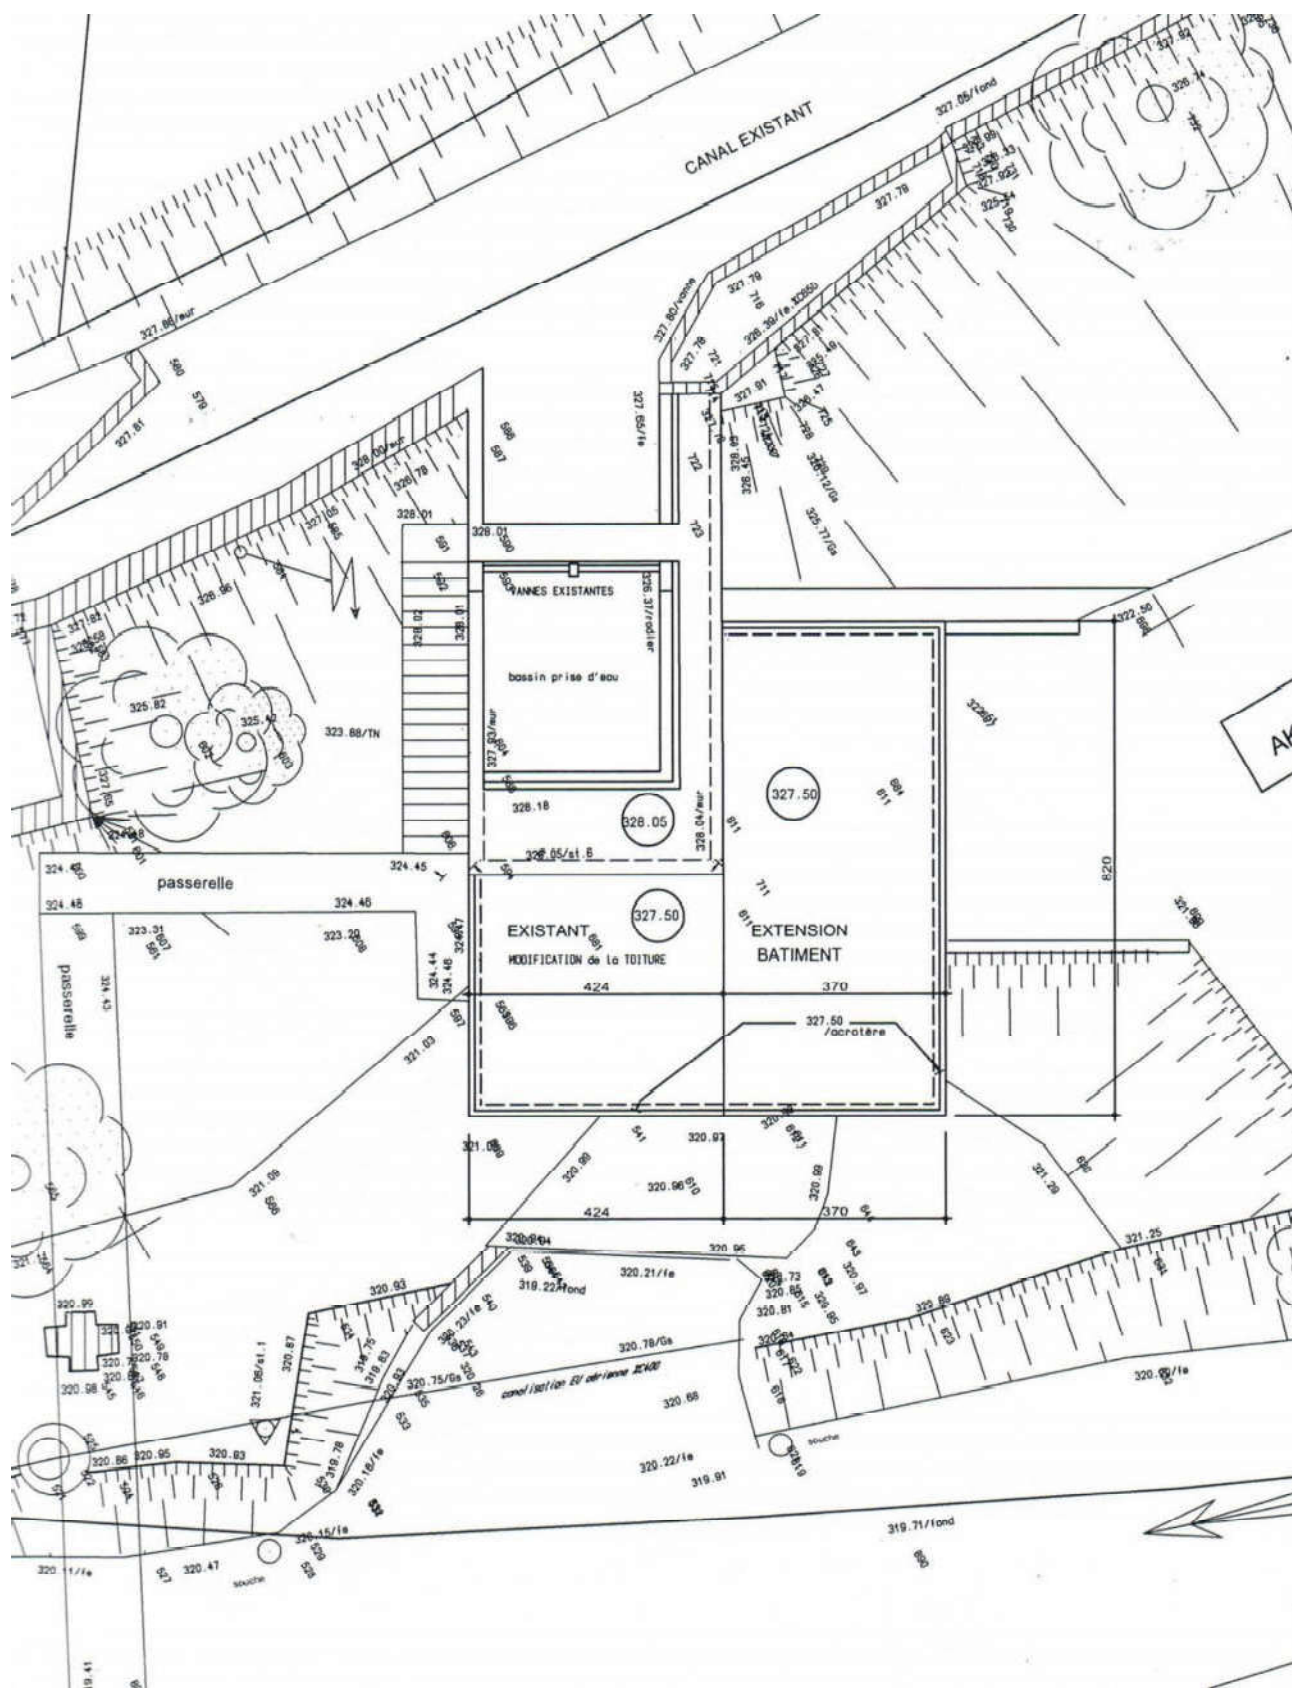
VUE EN PLAN DE L'EXTENSION DE LA CENTRALE DE BAS RIVES
